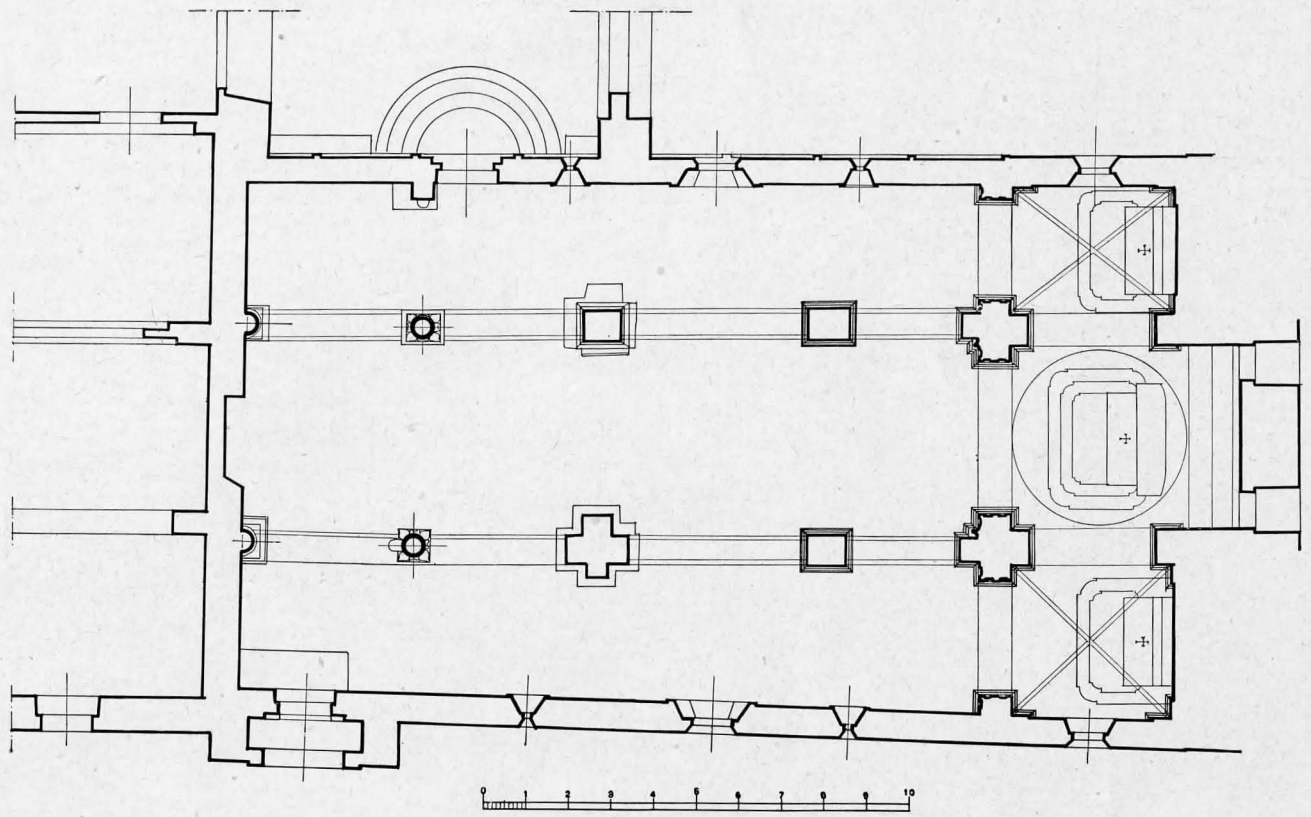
LA PIANTA PRIMA DEI LAVORI
